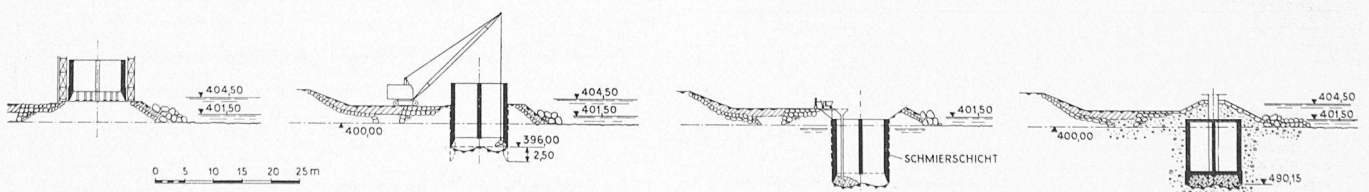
Baustadien des Strompfeilers links, Masstab 1:1300
